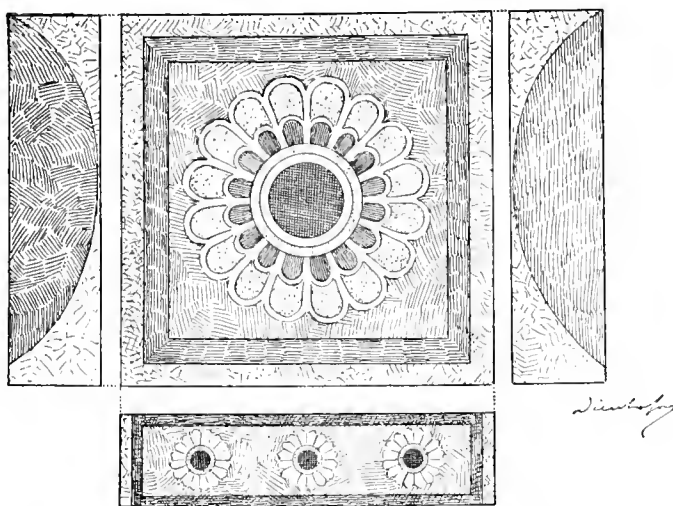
BALLE DES MAINS COURANTES. PLAN ET RABATTEMENTS DES FACES (FOUILLES DE SUSE).
